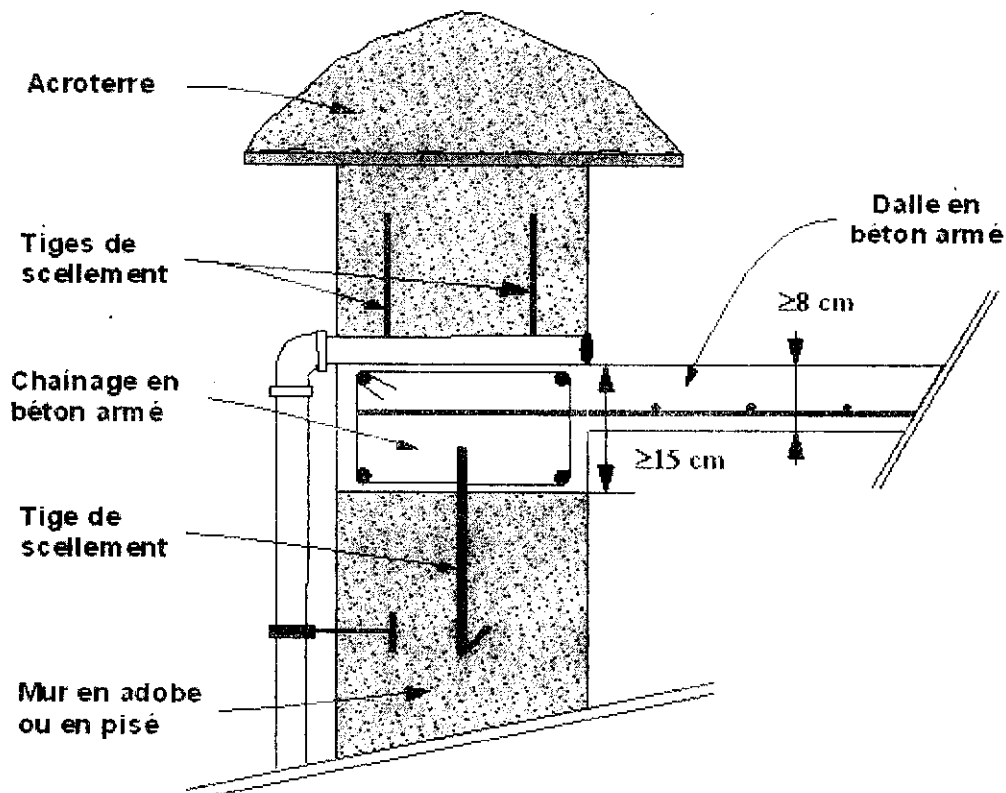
Chaînage horizontal en BA, toiture en BA attache mur – chaînage
